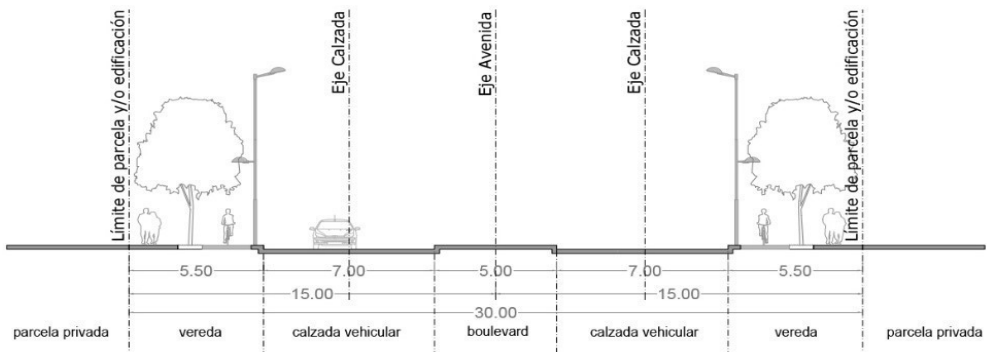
Sección transversal de Vías Avenidas Tipo 4.
